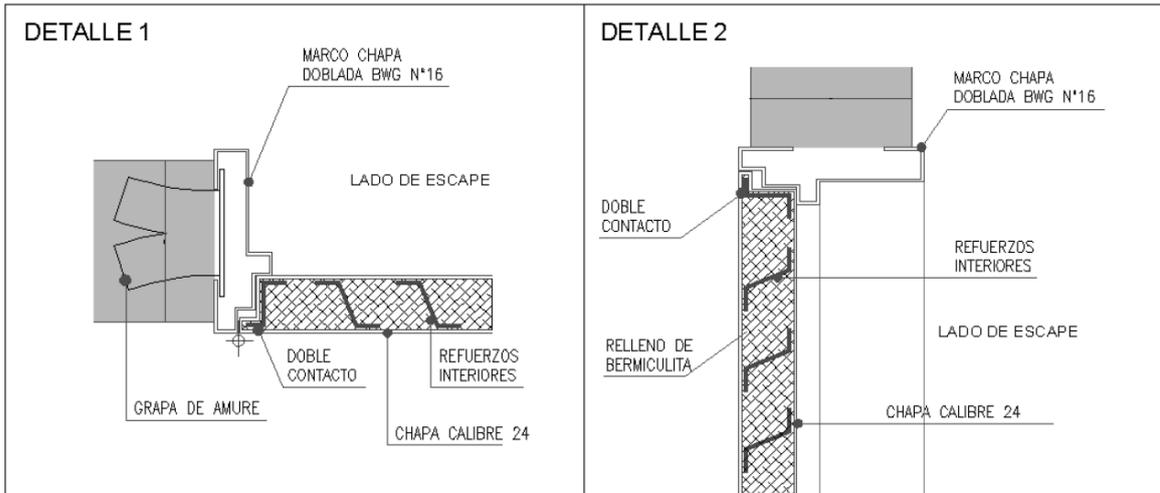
Detalle constructivo de puerta de caja de escalera.
